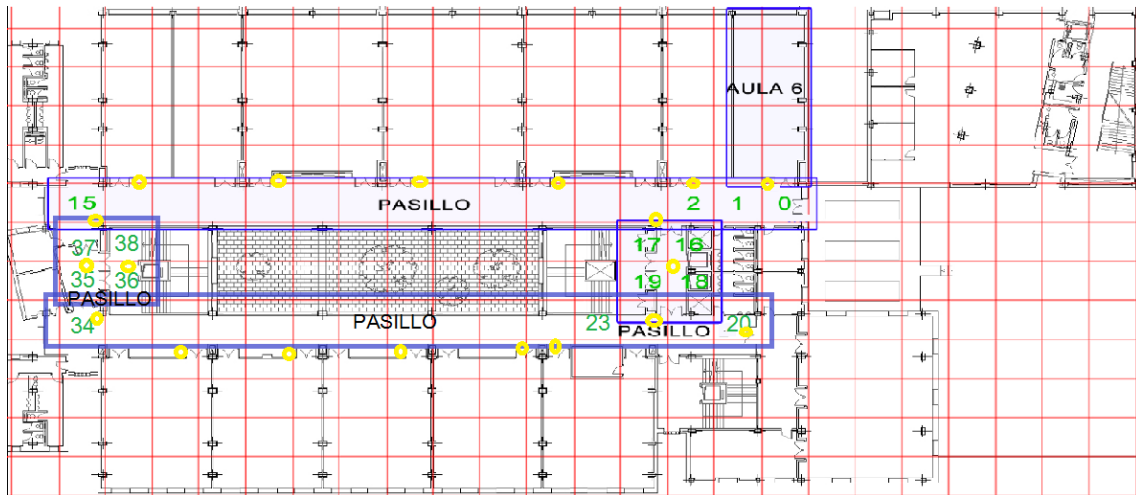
Primera versión del mapeo de la primera planta de la Facultad de Informática.
